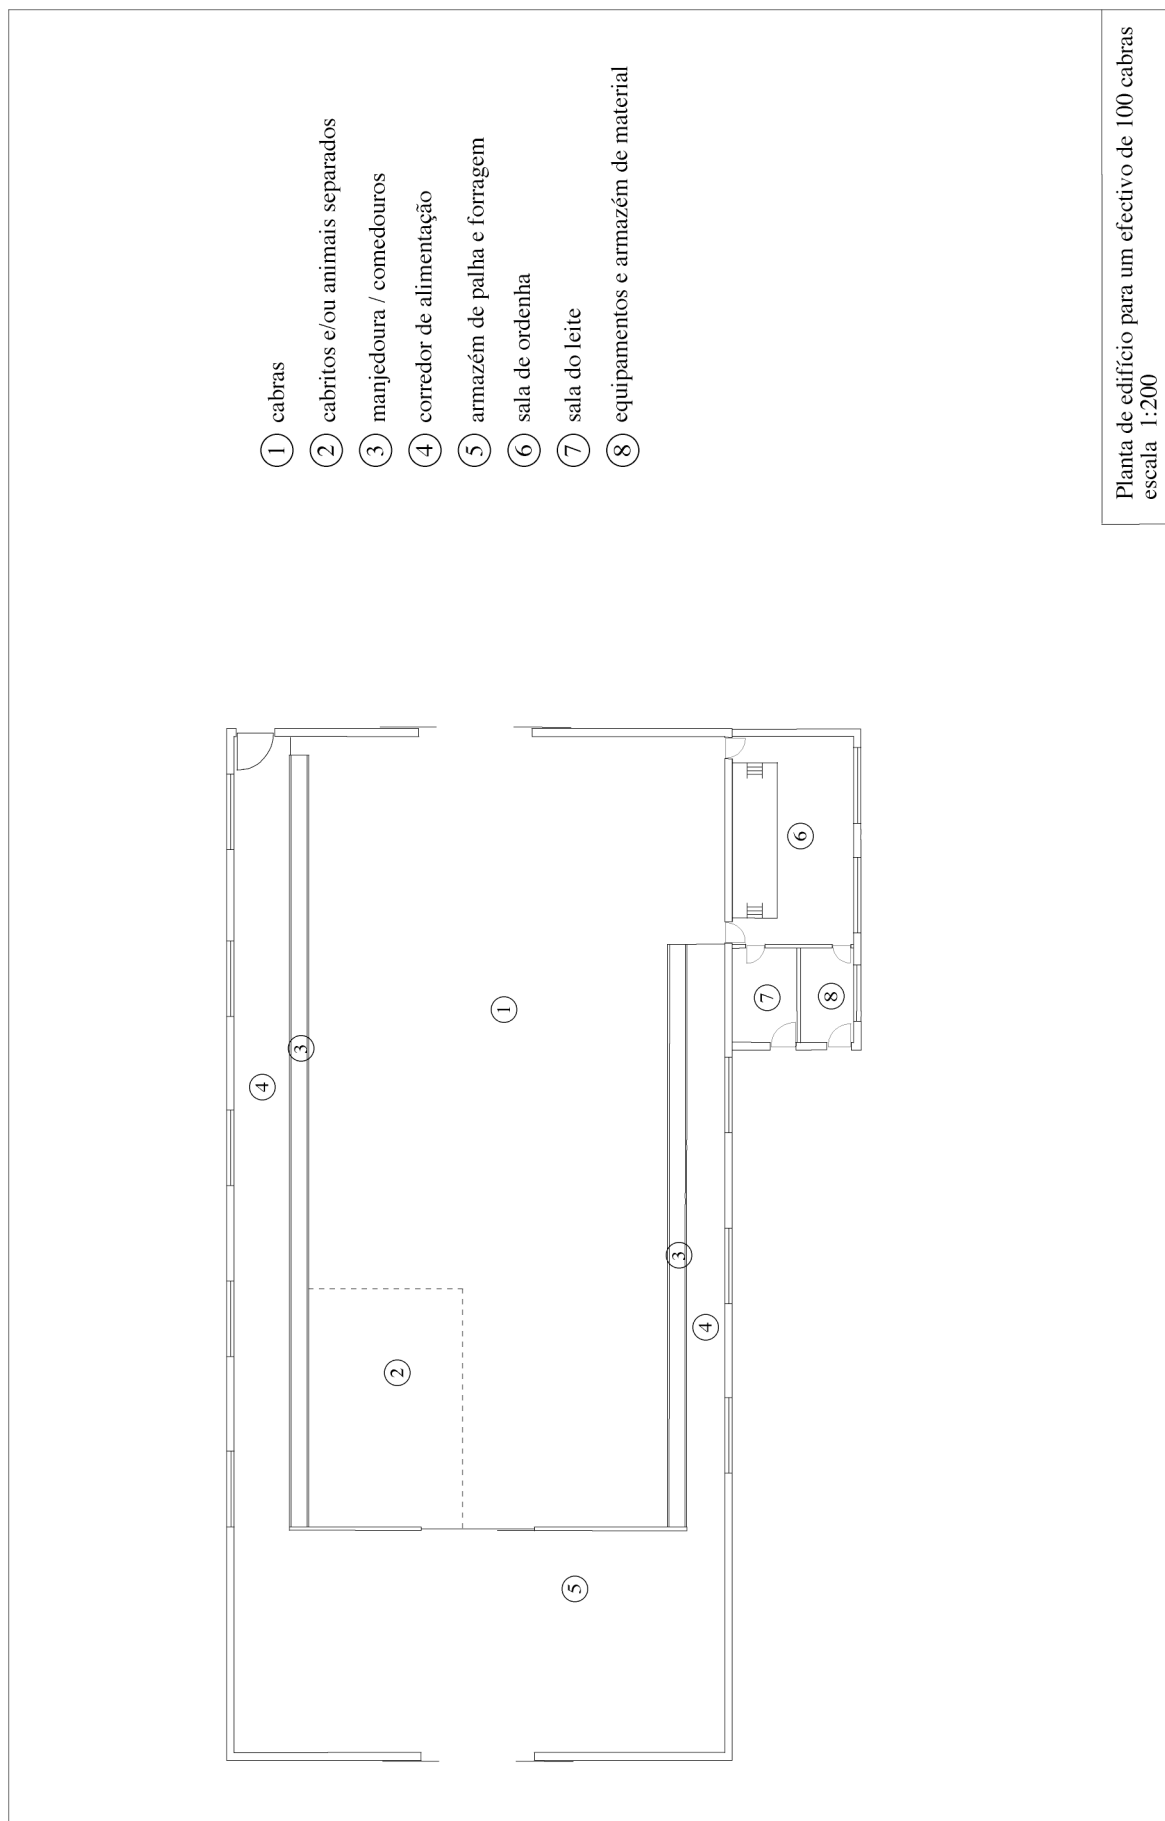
Planta de edifício para alojamento de um efectivo de 100 cabras adultas.
